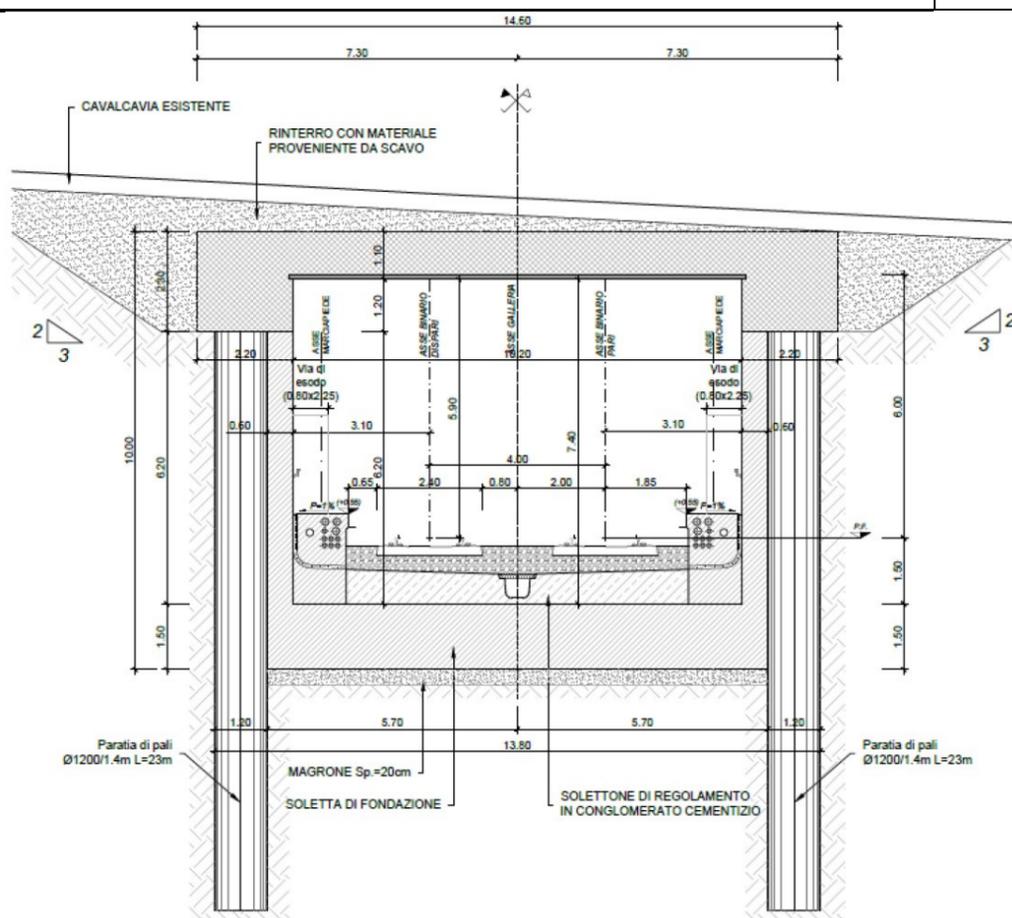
Sezione tipo GA – Tipo 3 a doppio binario.
